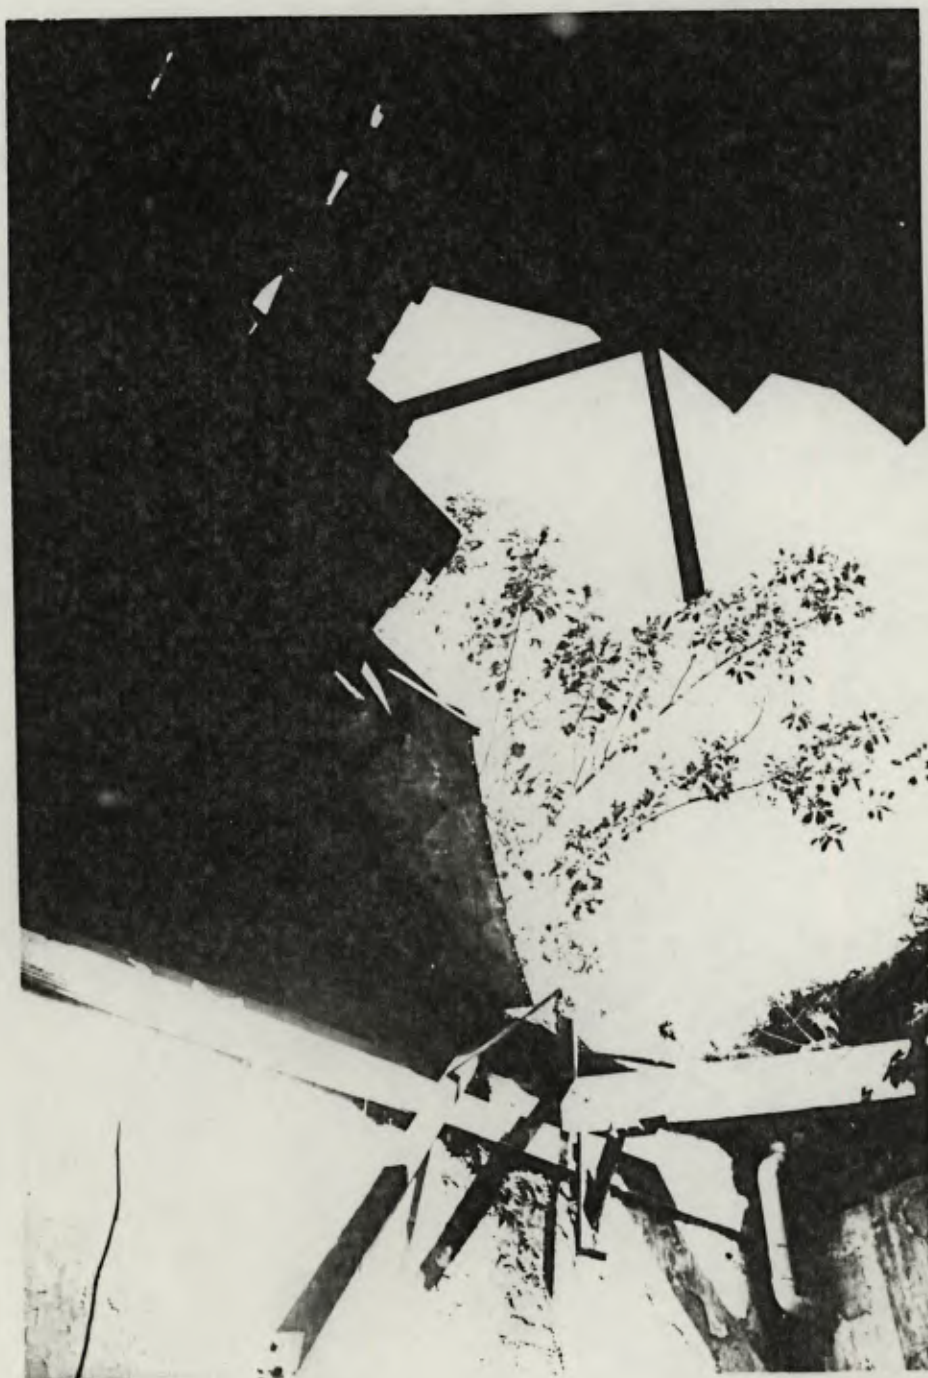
Detalhe interno do forró e telhado ruídos nos aposentos da fachada oeste.
